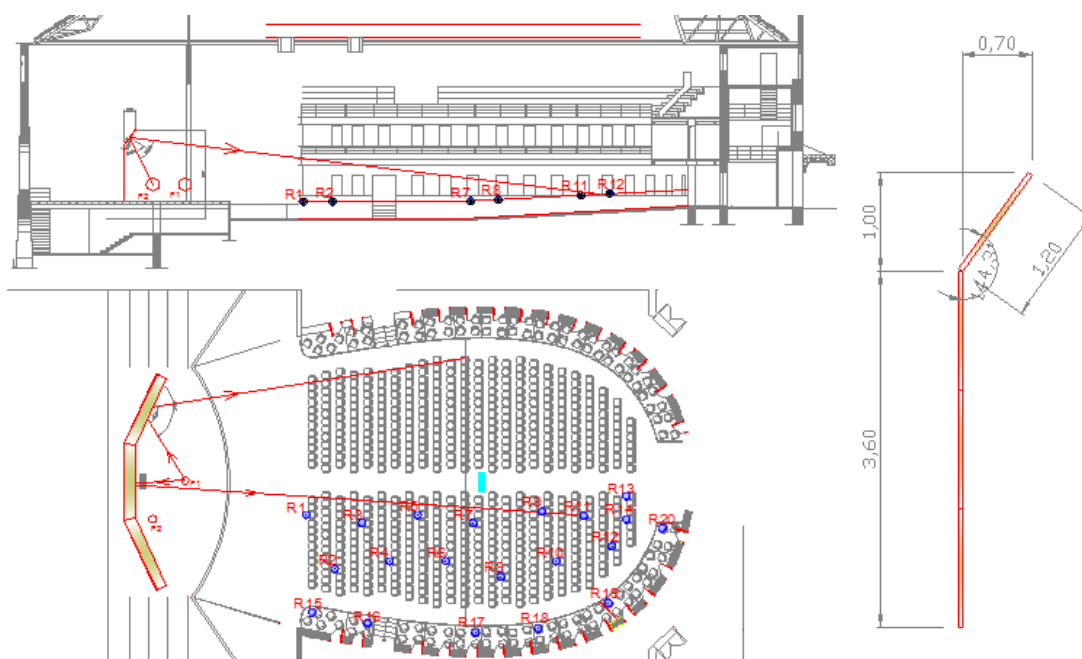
Planta e corte com possíveis reflexões, e pormenor do perfil da canópia
